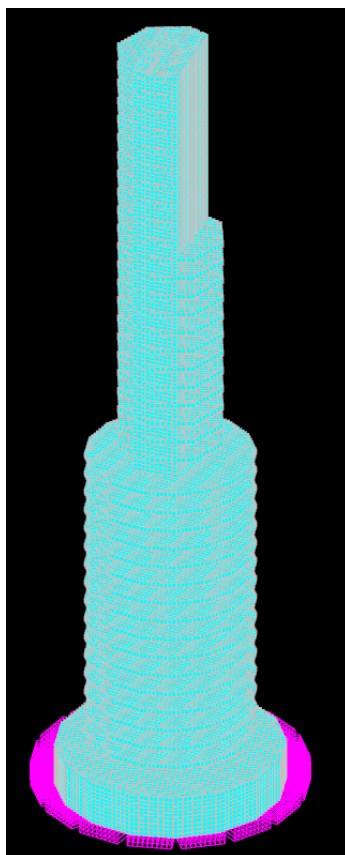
Постоянные нагрузки от грунта
